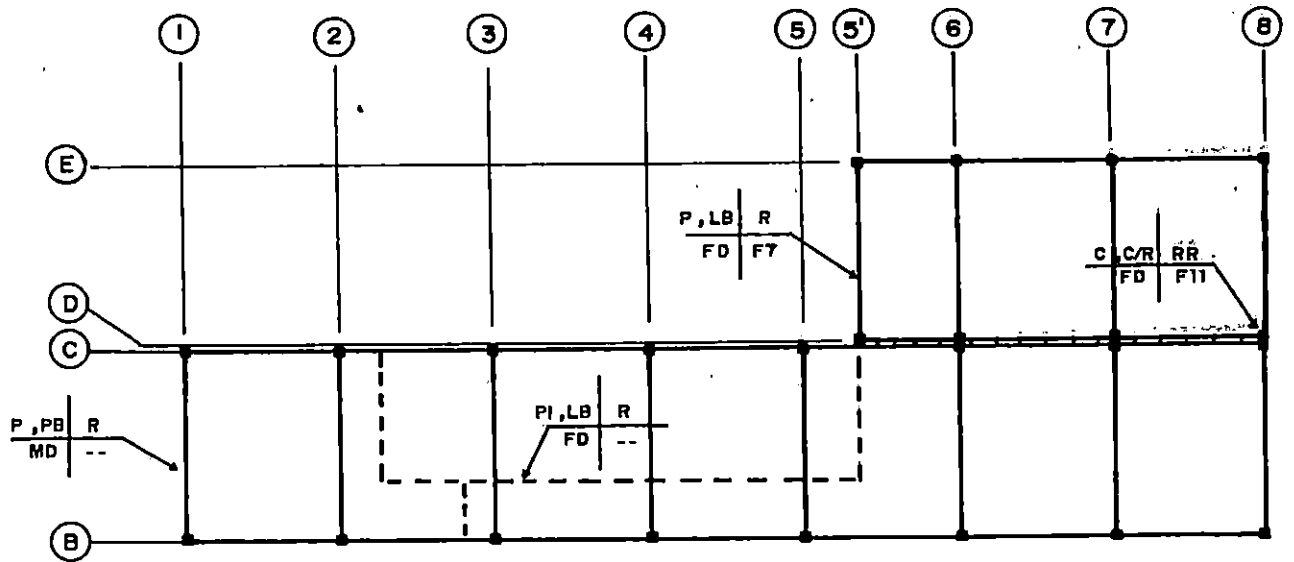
PLANO DE DAÑOS " 1er. ENTREPISO "
